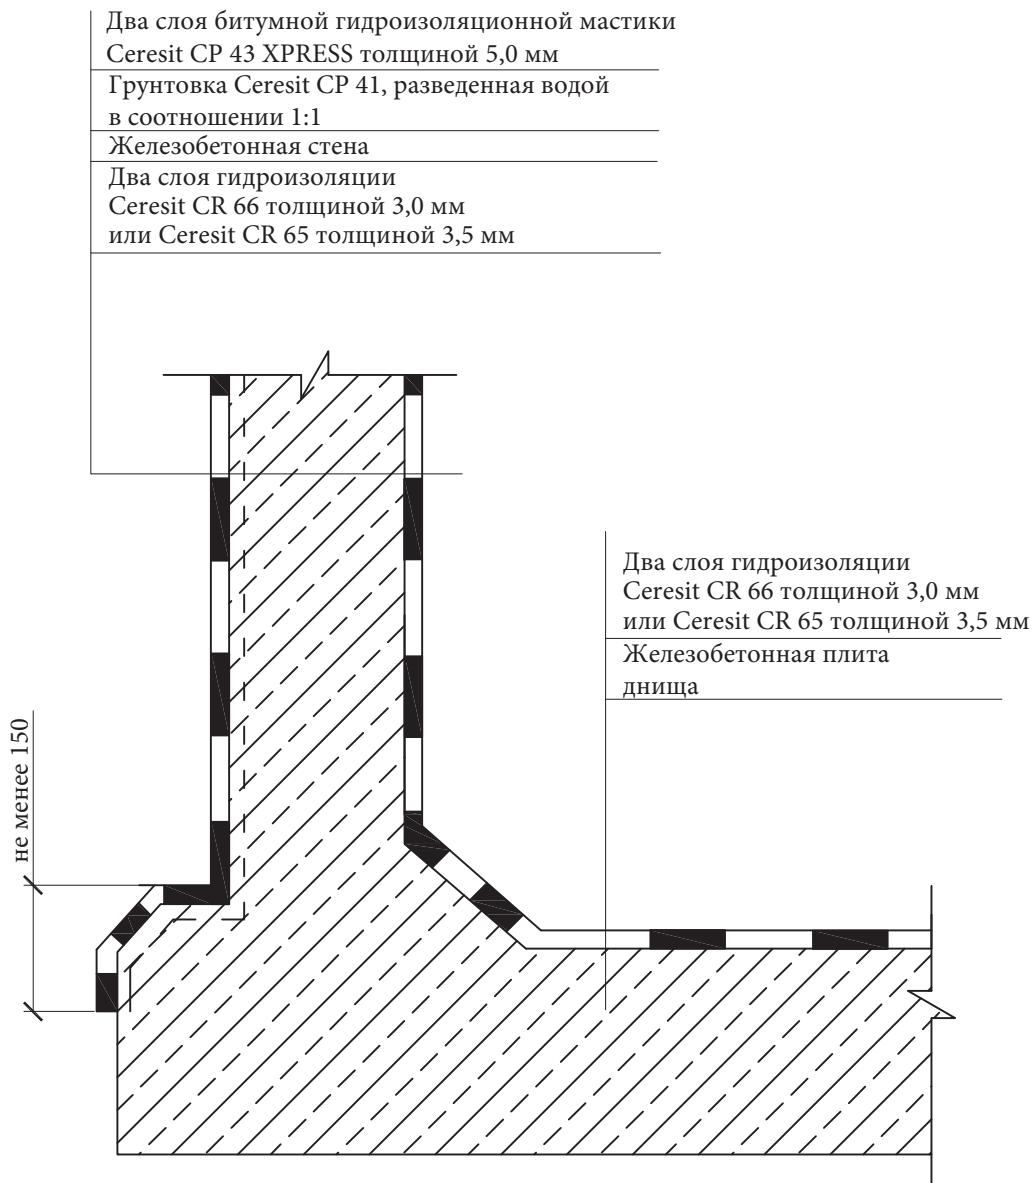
Конструкция системы гидроизоляции монолитных резервуаров для питьевой и технической воды без облицовки
